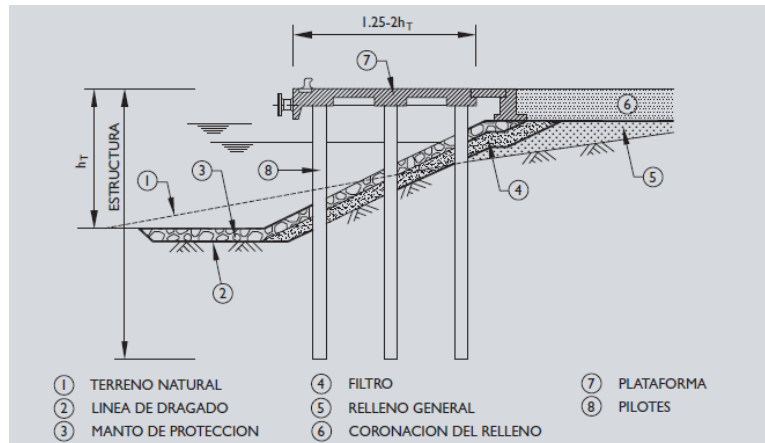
pantalan cimentado con pilotes. Fuente ROM2.0-11
